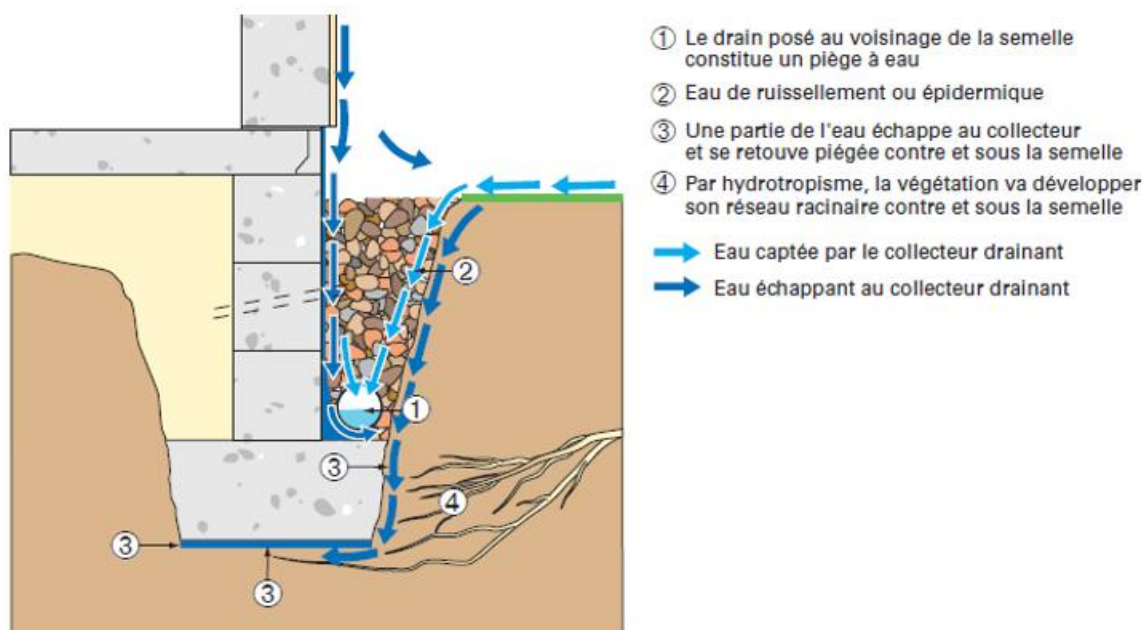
Drain de pied contre les fondations, facteur déclenchant (Béchade, 2021)
